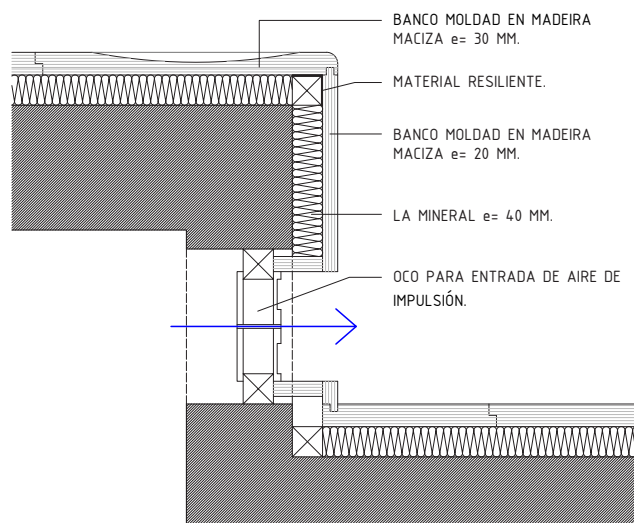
Detalle constructivo dos ocos na bancada para entrada de aire no espazo principal. Escala 1/10.
